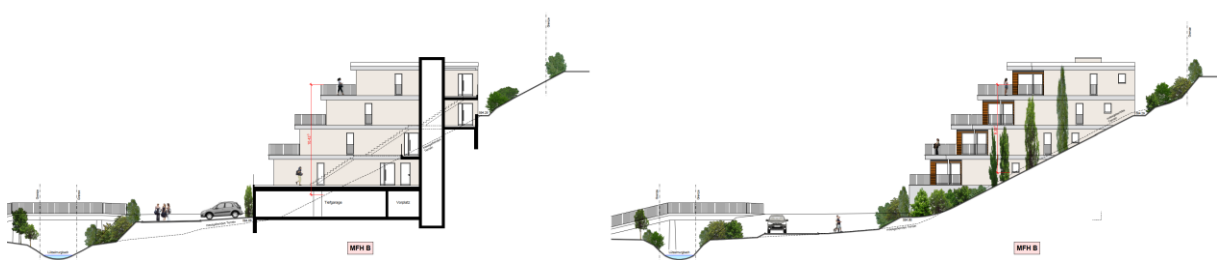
Richtprojekt: Fassadengestaltung, Ostfassaden
